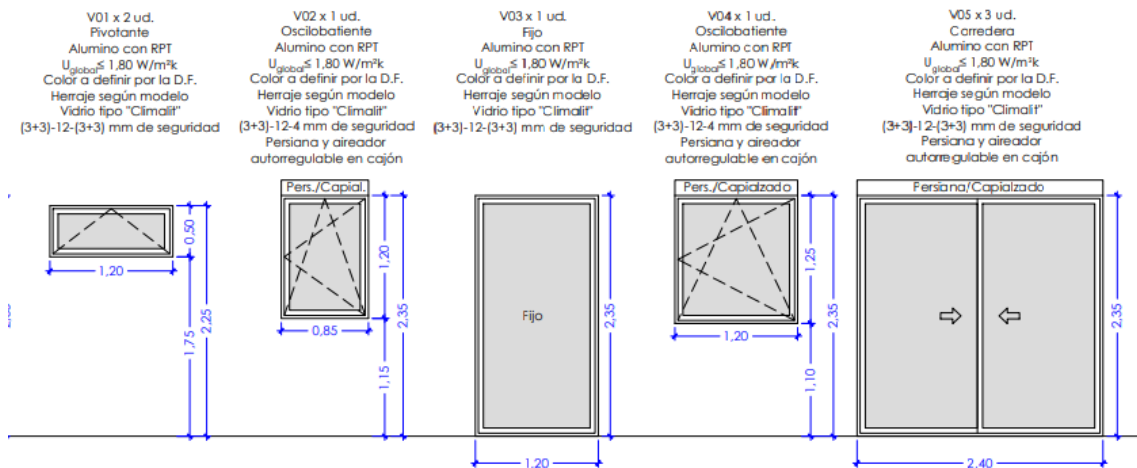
Plano de carpintería. Fuente: proyecto básico.
